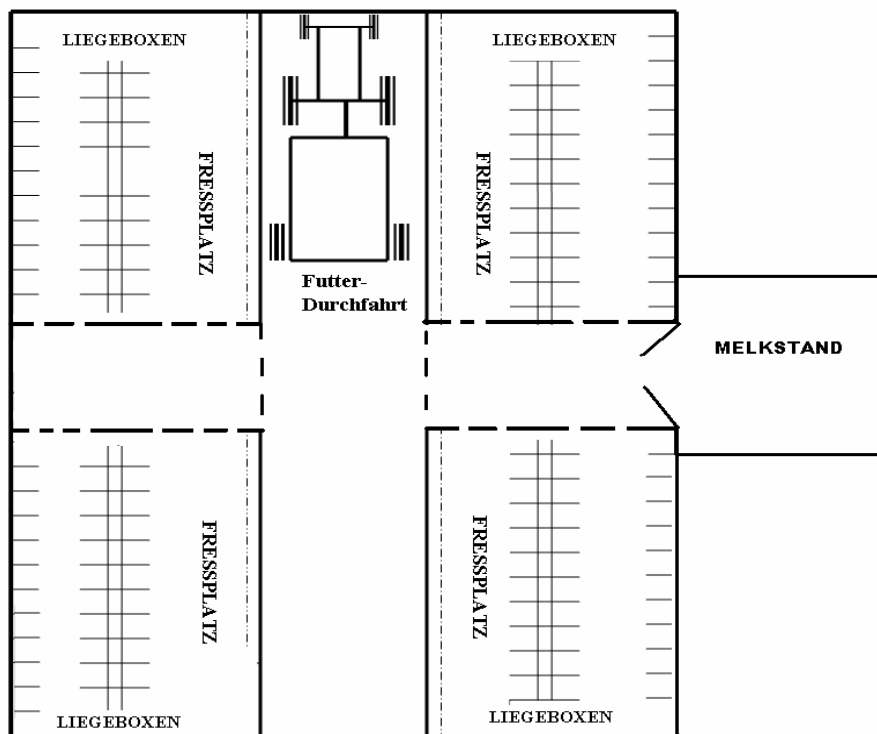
Grundriss- Schema Velvet-Farm
